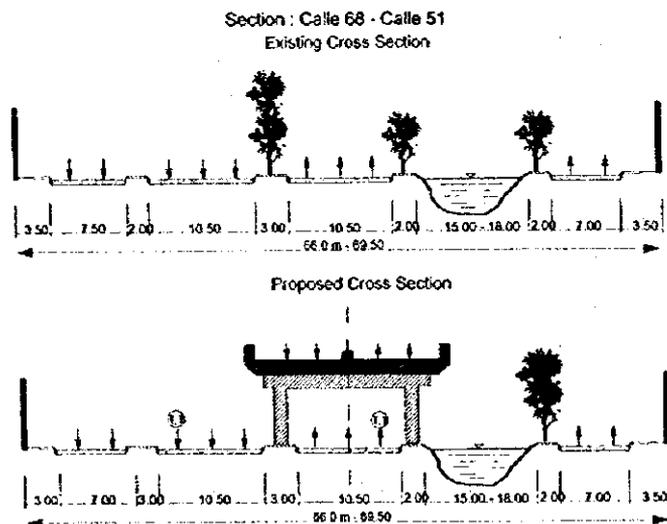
Sección Típica sobre la Avenida Quito (3)
